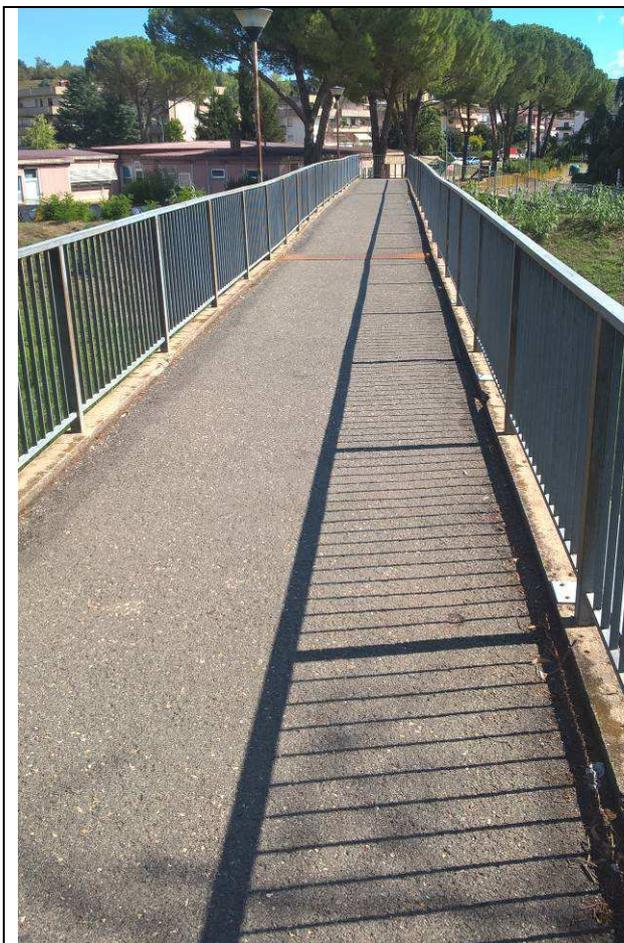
Vista generale dell'impalcato della passerella con pavimentazione asfaltata
